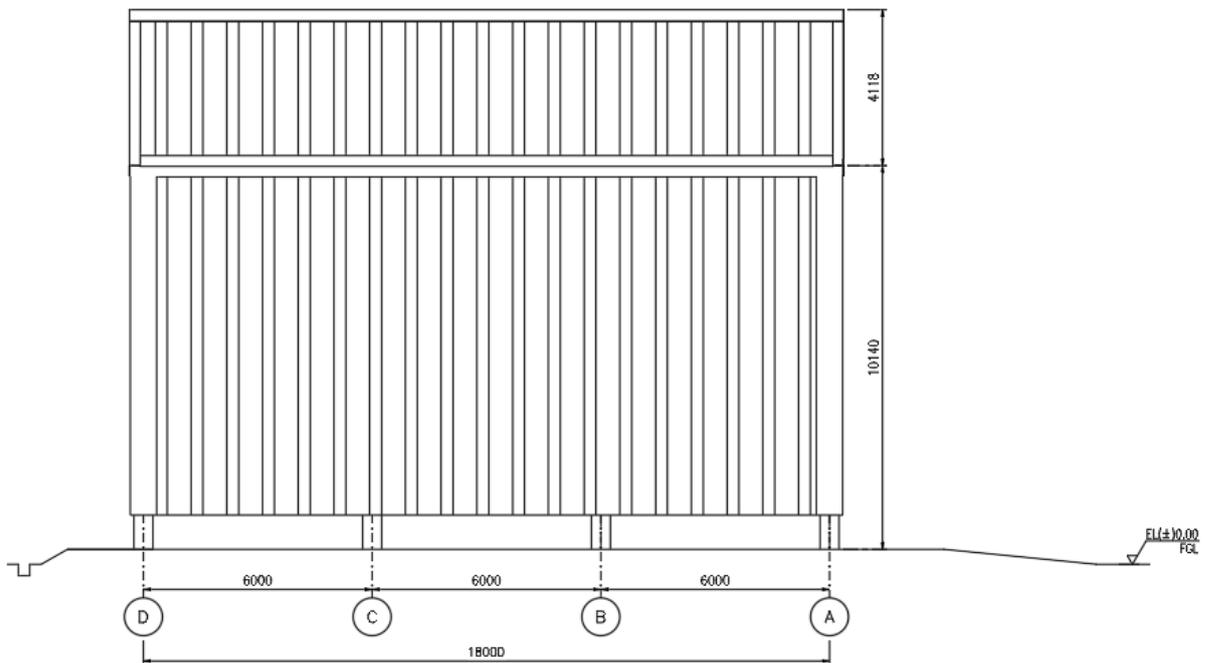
Denah Perencanaan Pembangunan Hanggar
